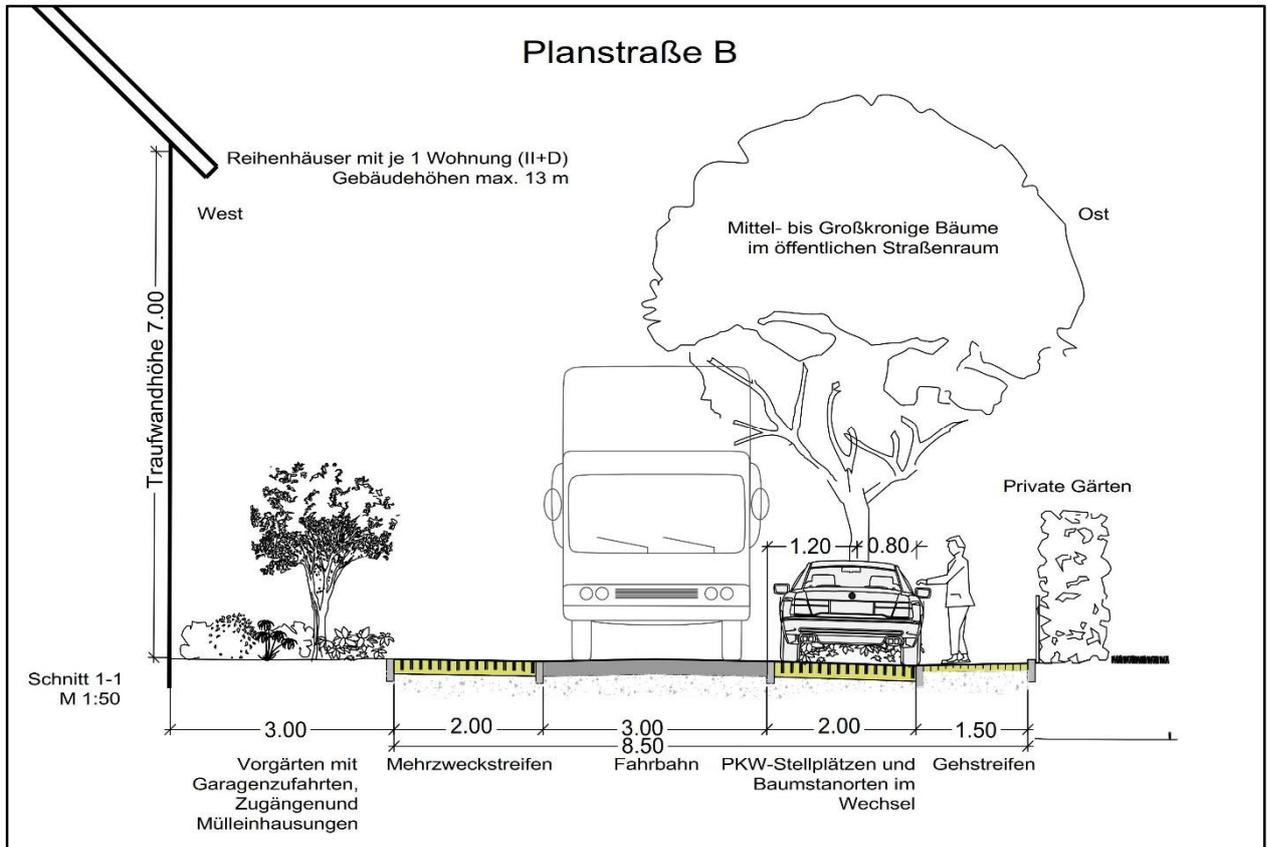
Straßenquerschnitt 8,5 m (Planstraße B)
